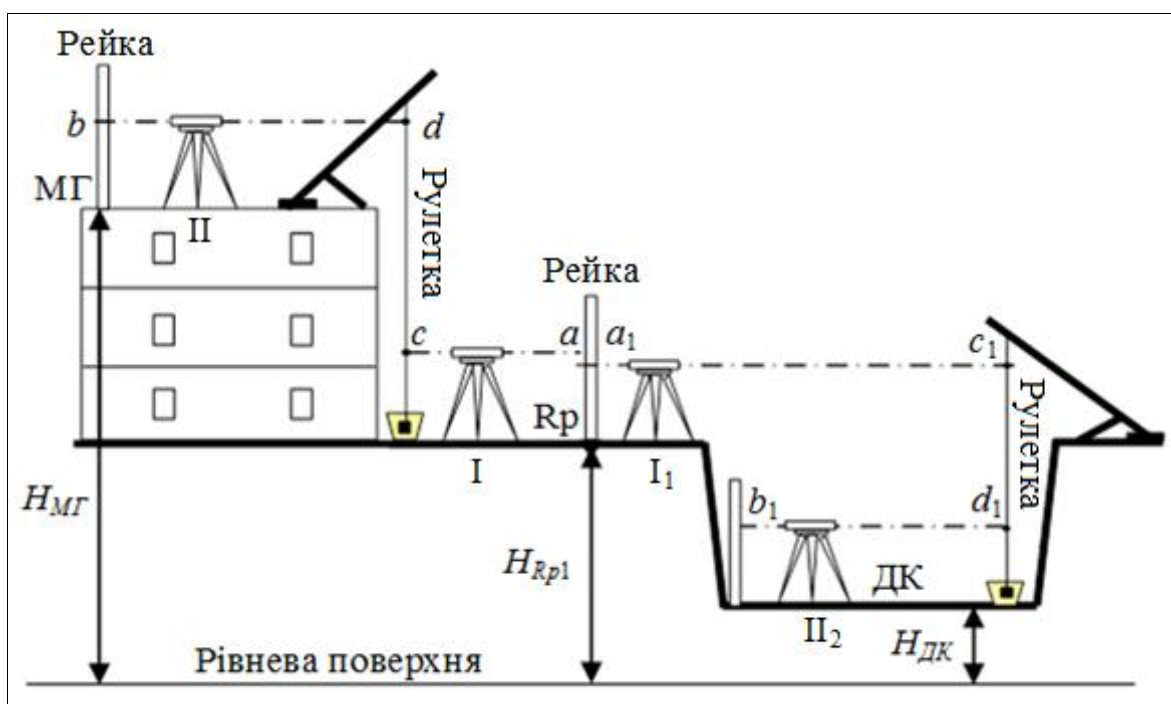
Схема передачі позначки на монтажний горизонт (МГ) та на дно котловану (ДК)
